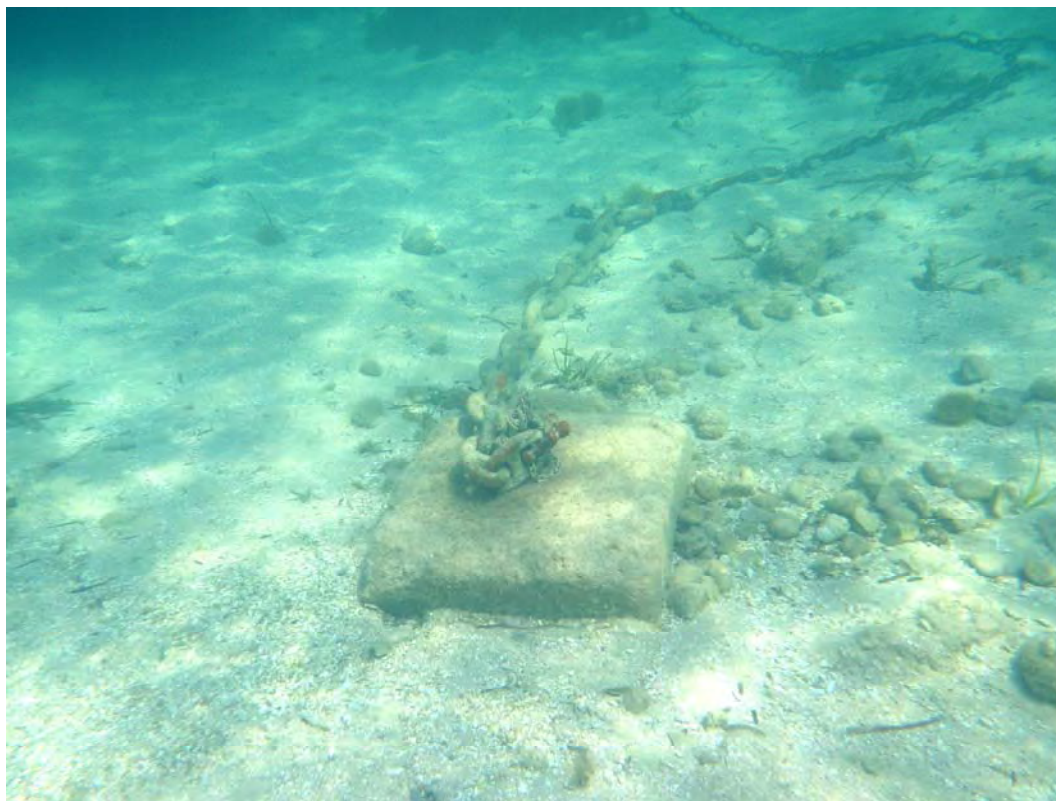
Lastre de hormigón y tren de fondeo con cadena de amarre.
